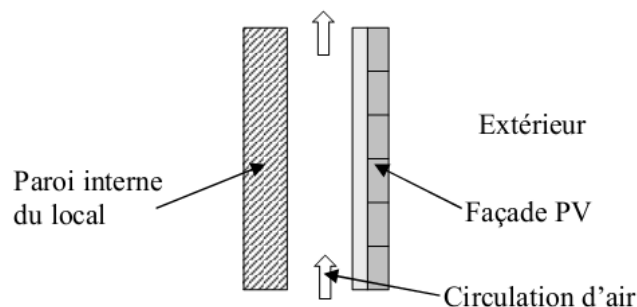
Coupe de la lame d'air en sous-face des panneaux PV [Sandberg 1998]
